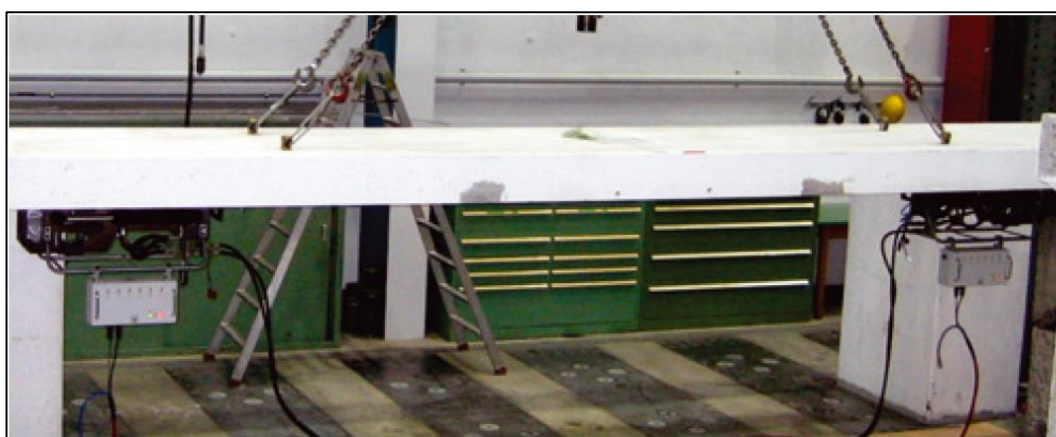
Dispositivo de pretensado desarrollado por Stoecklin y Meier - montaje en una viga [Garcez M.R., G.L. Silva Filho, U. Meier (2012)]
